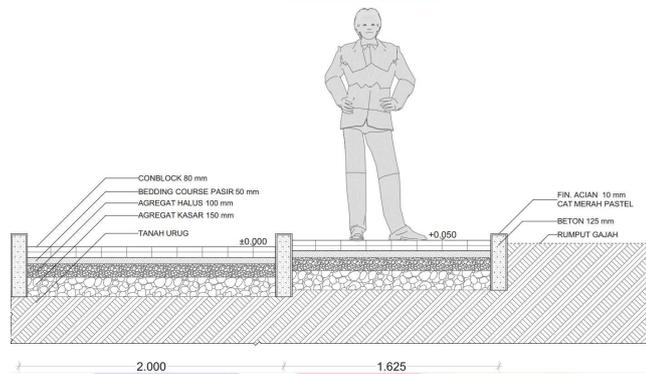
Detail Pertemuan Ruang Luar dan Ruang Dalam
